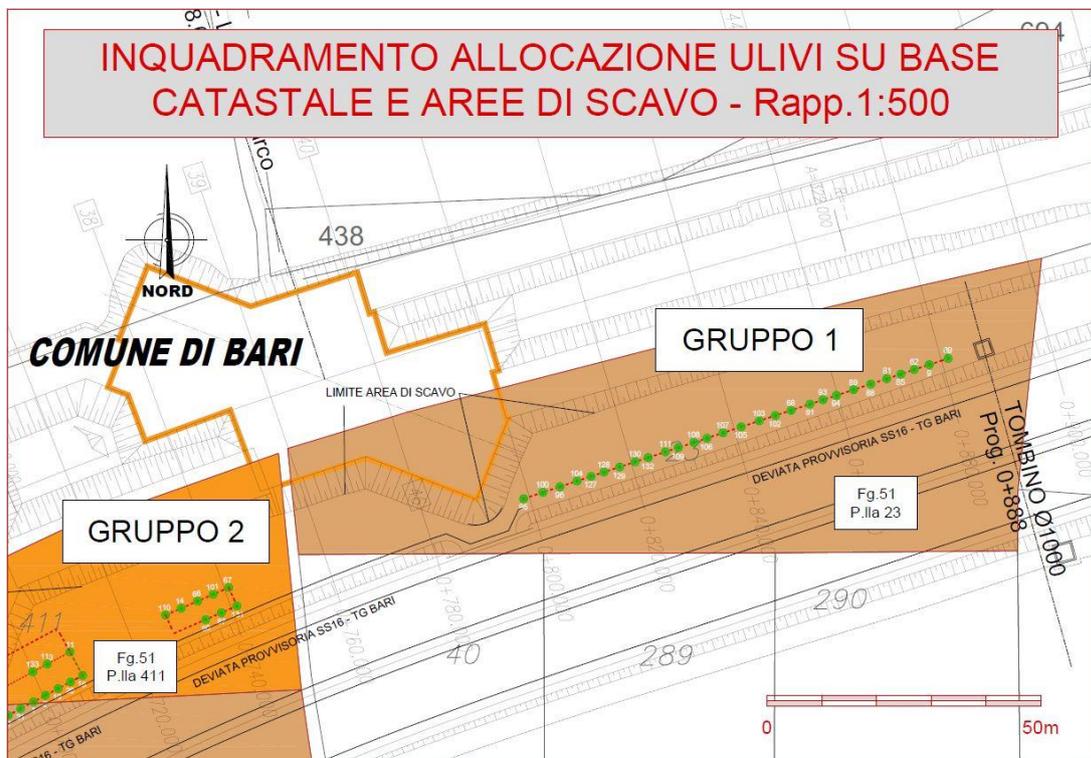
Planimetria attuale dei Gruppi 1 e 2
